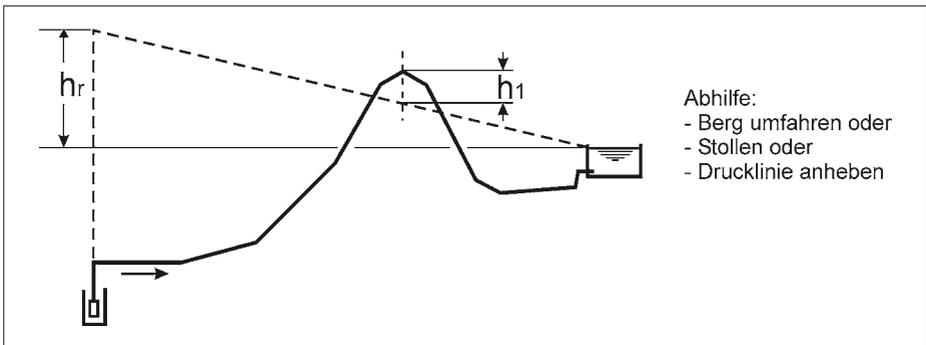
Unzulässige Führung einer Pumpendruckleitung
